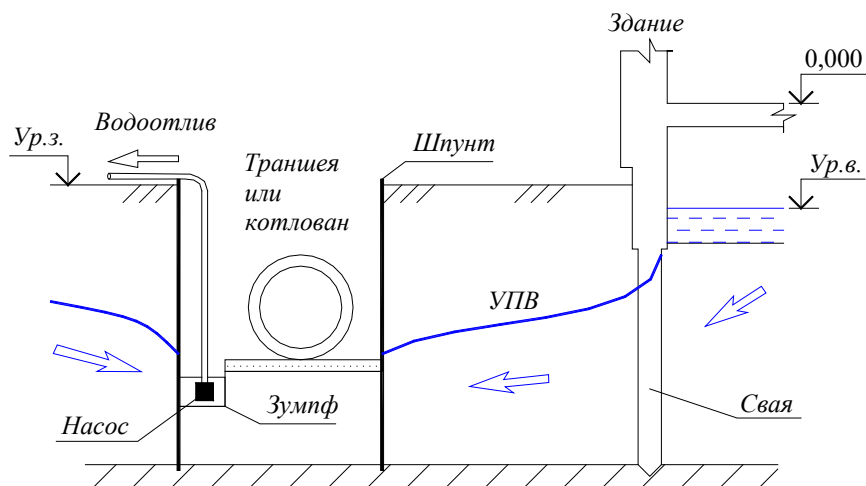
Крепление стенок котлована или траншеи с водоотливом
